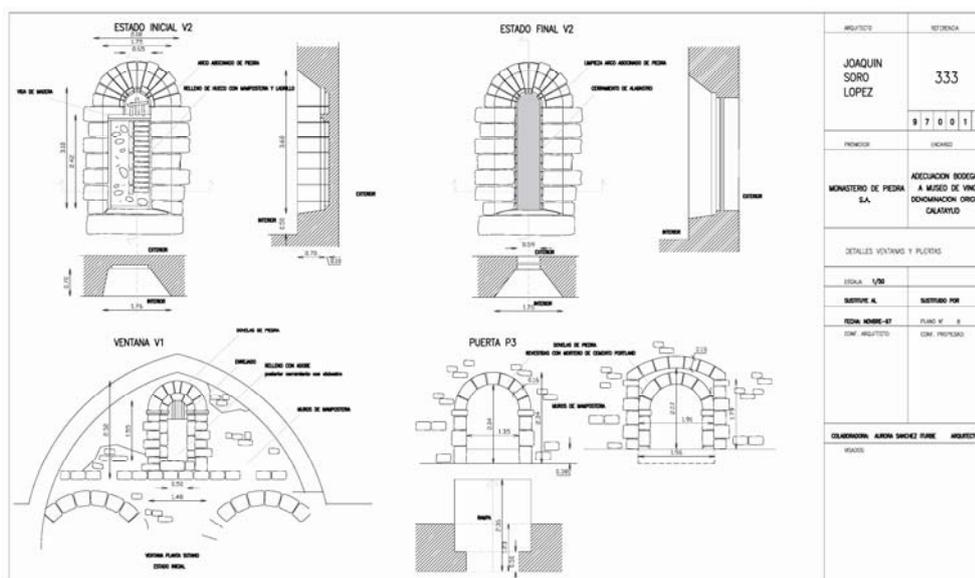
([AJS] Proyecto Nov 1997, plano 8) DETALLES VENTANAS Y PUERTAS
